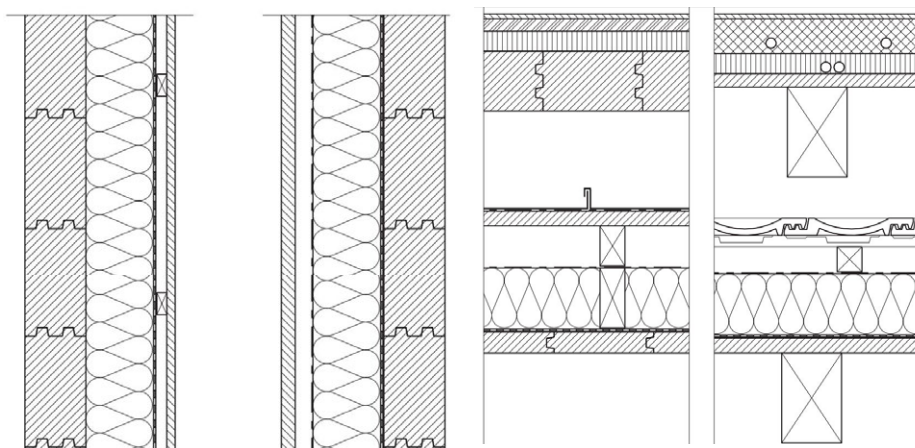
Montaje de las placas prefabricadas en la Casa Willmann-Lötscher (1998), Bearth&Deplazes
